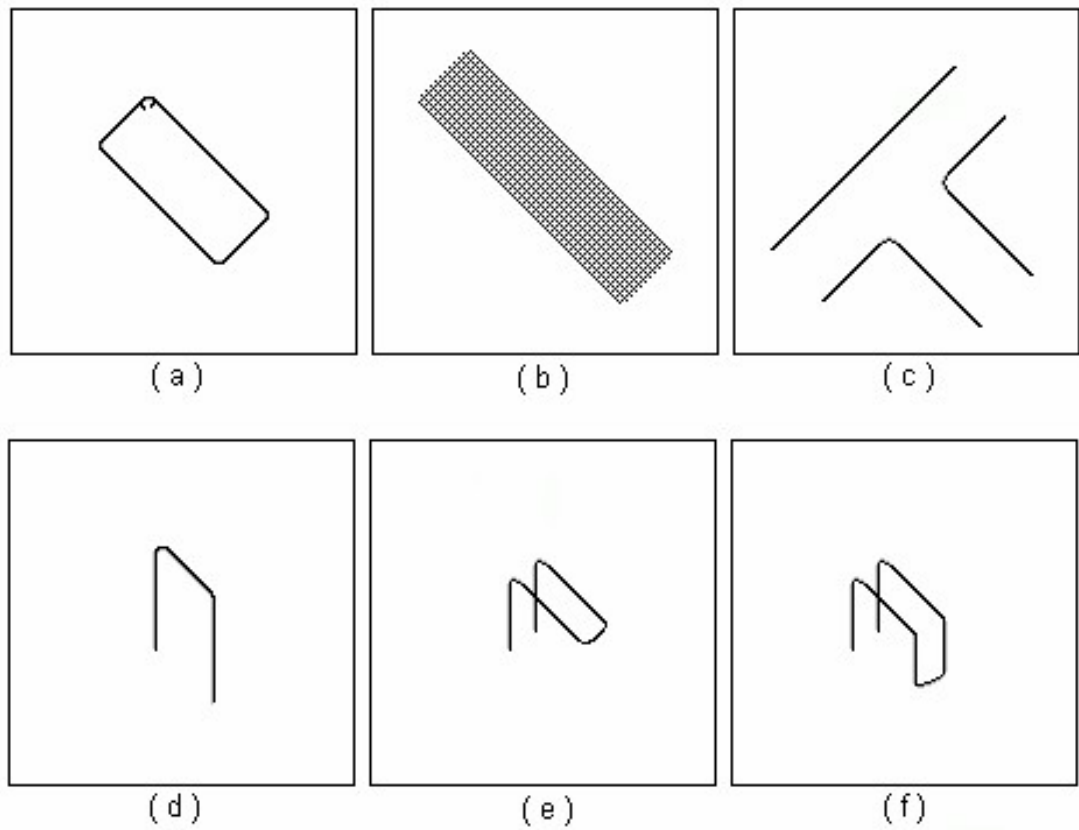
Armaduras utilizadas na amarração indireta (SANTOS, 1998).
